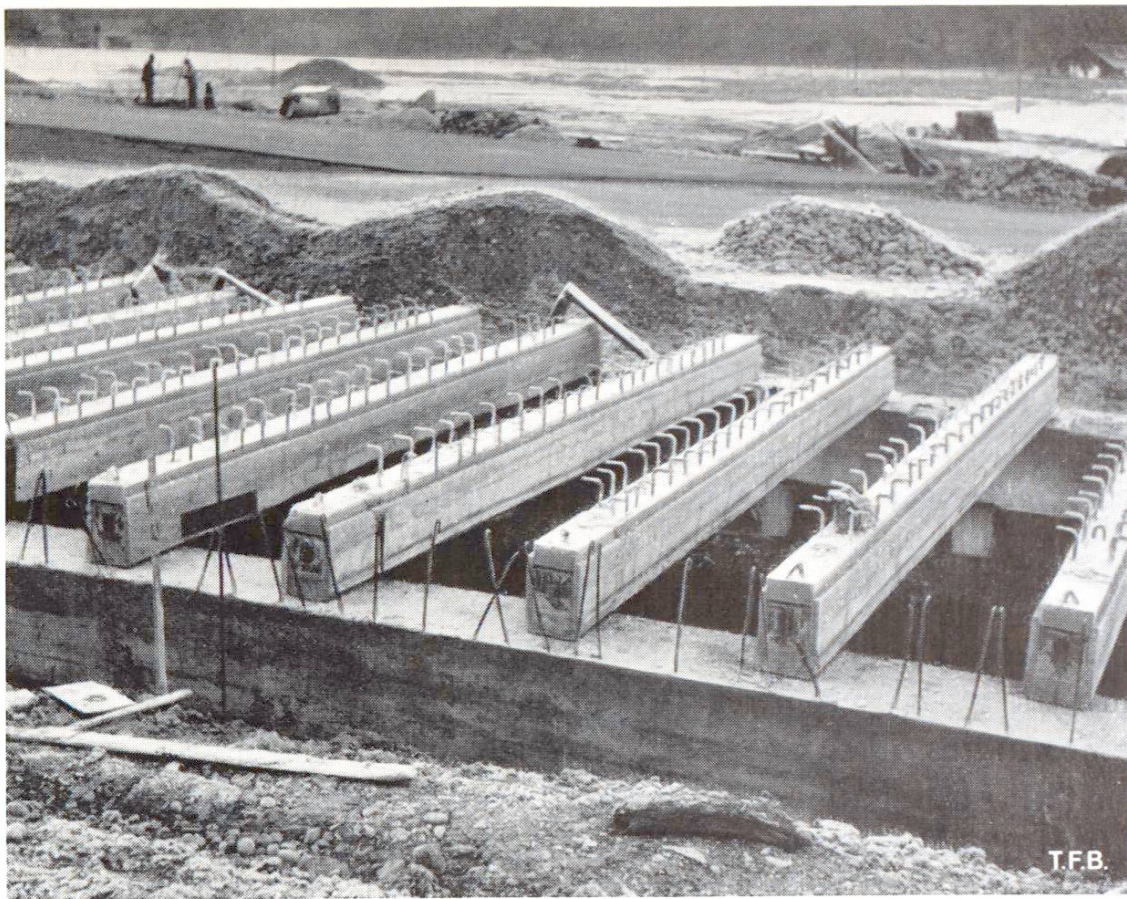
Couverture d'un torrent au moyen de poutres préfabriquées en béton précontraint. Portée 6 m
